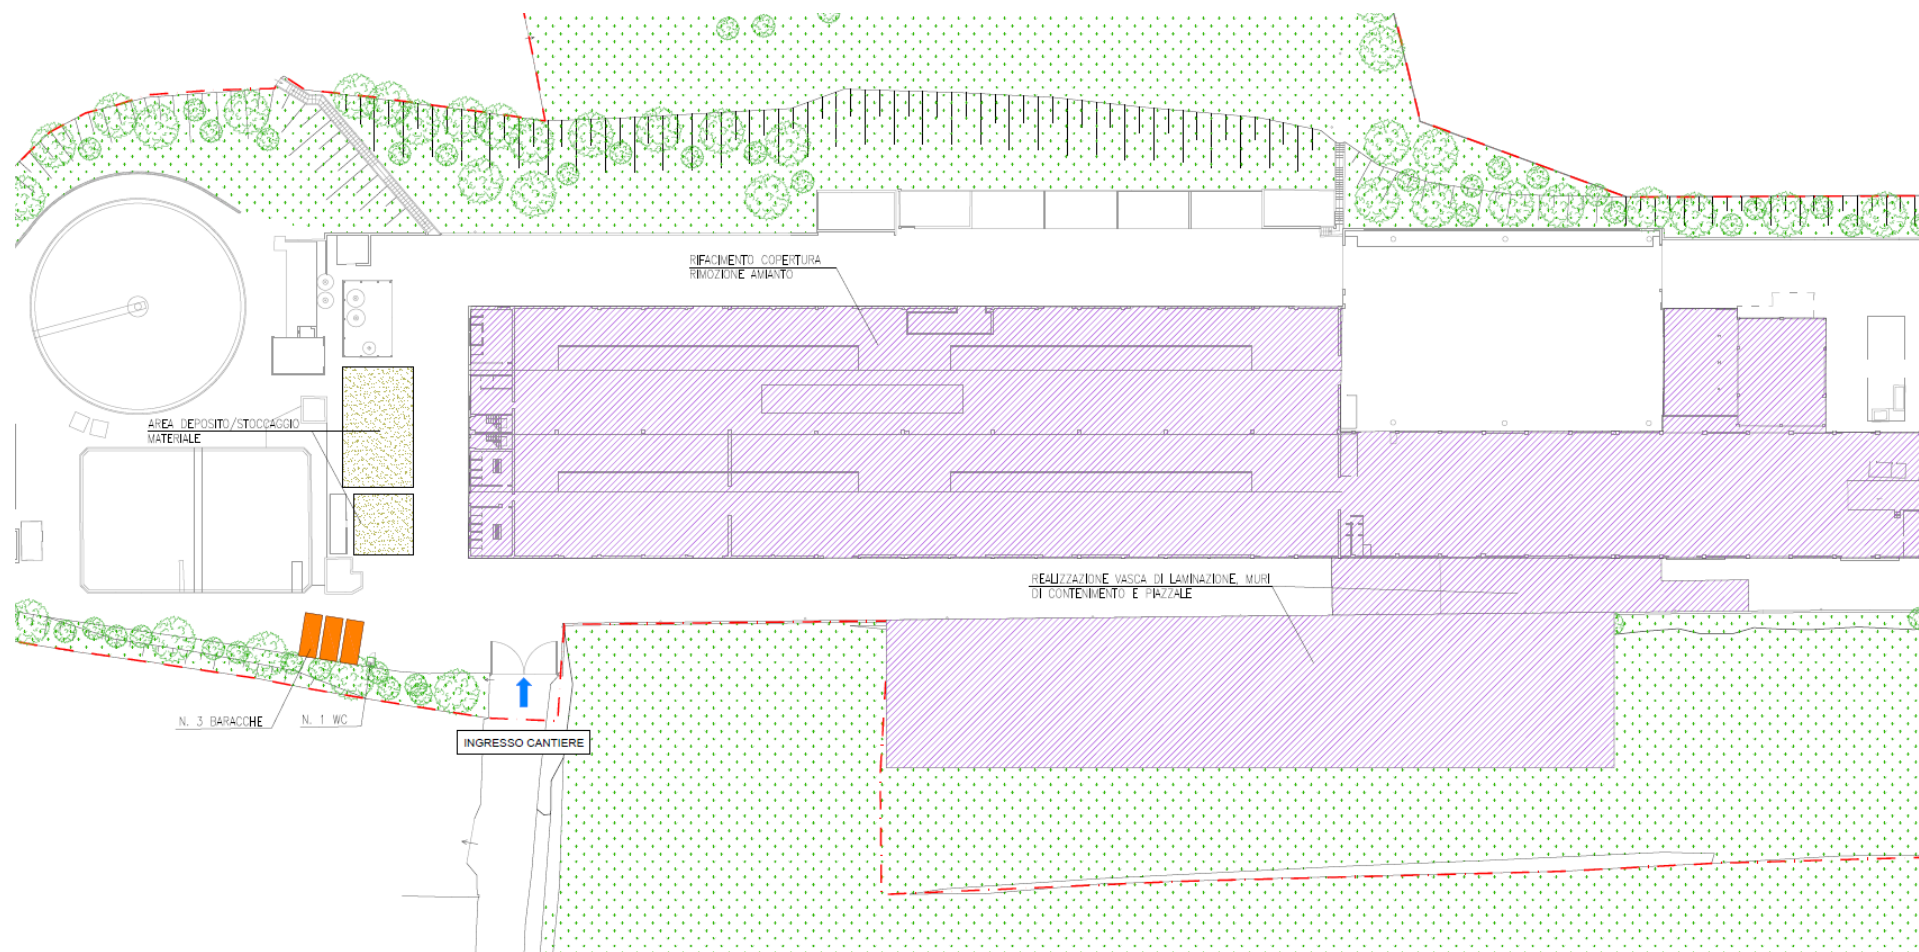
Planimetria area di cantiere durante le fasi di cantiere numero 1 e 2 [Fonte: stralcio elaborato PD A.3]
